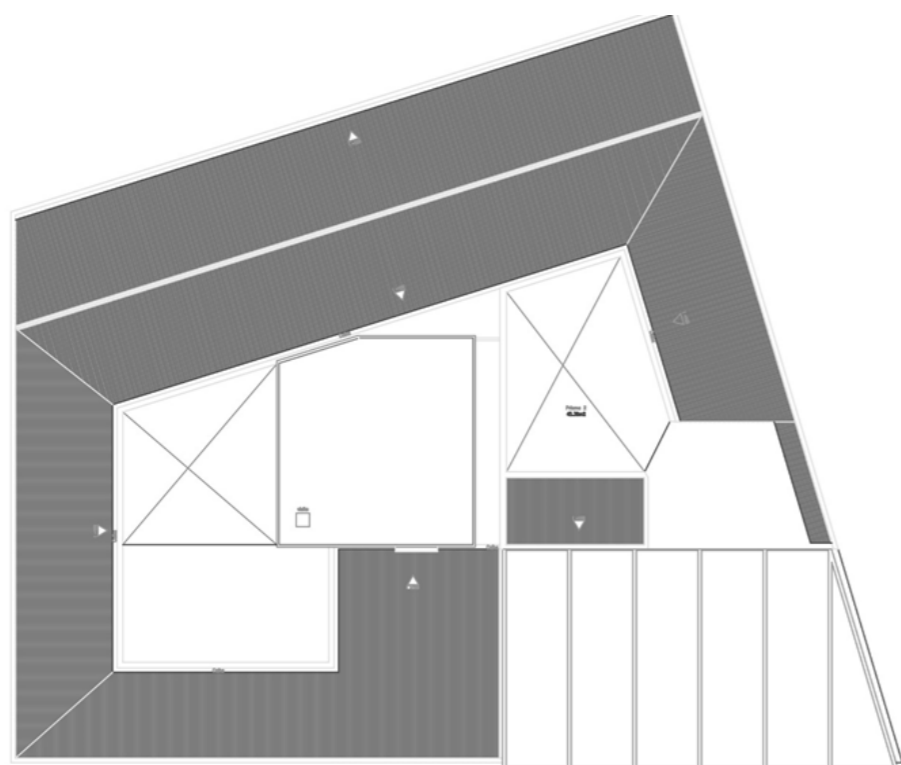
Planta baixa do 8º Pavimento do edifício (Escala 1/250)
